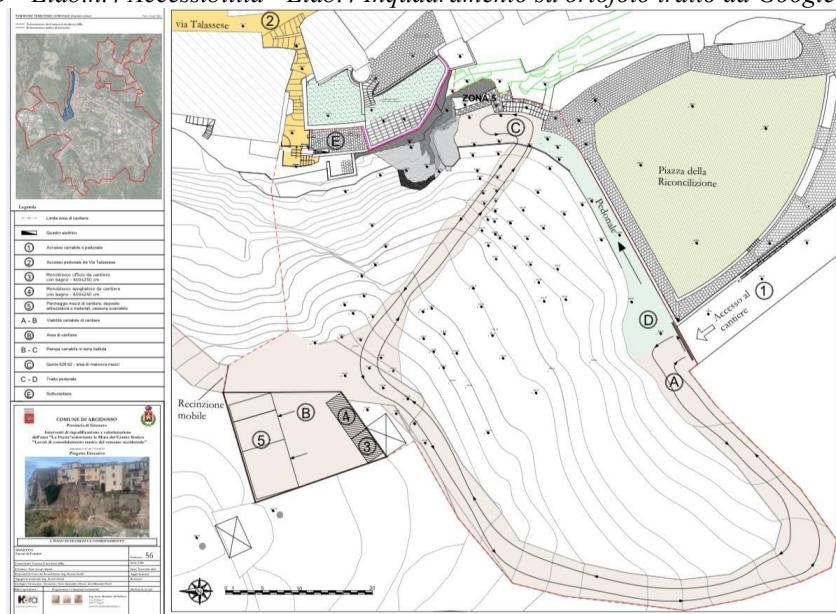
Elab.n.22 Planimetria con individuazione degli accessi pedonali e carrabili
